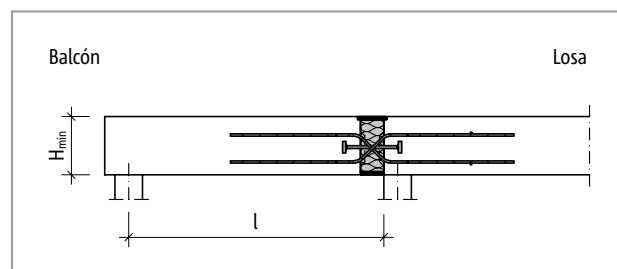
Schöck Isokorb® T tipo Q-P-VV: Sistema estático
